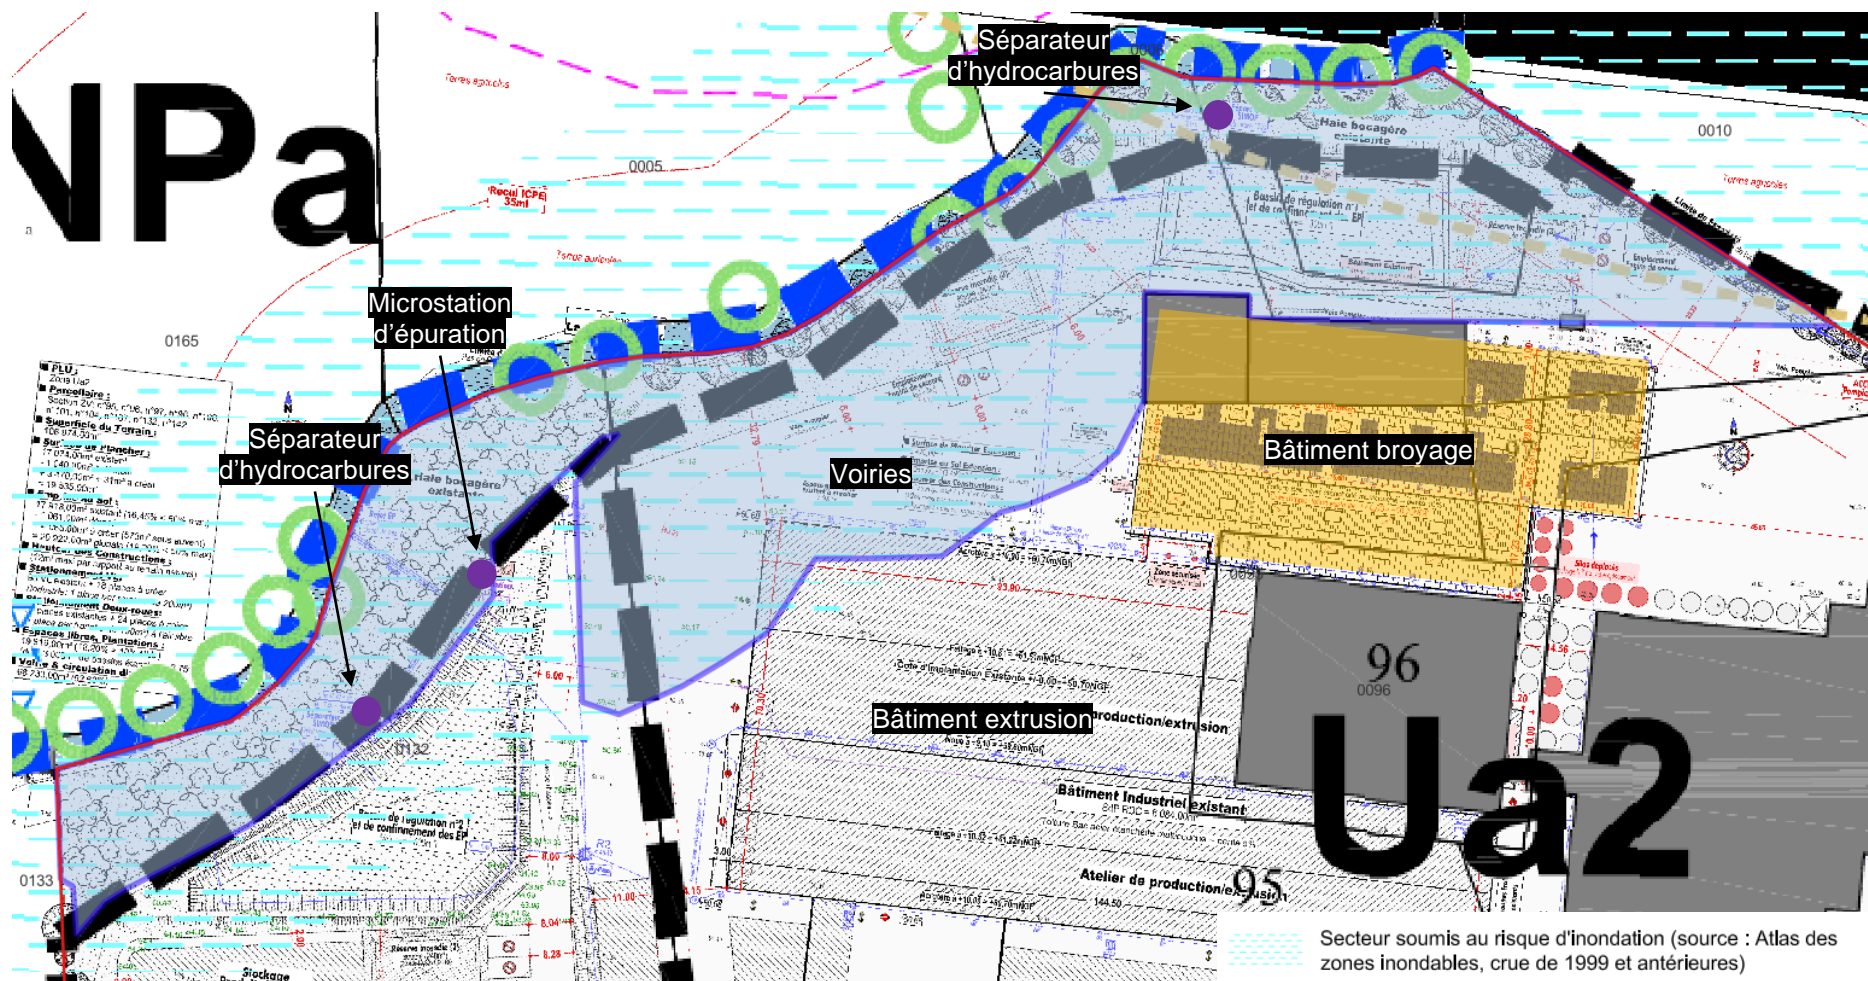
Superposition du plan masse du projet et du secteur soumis à risque d'inondation du PLU (Source : PLU de Bais)
